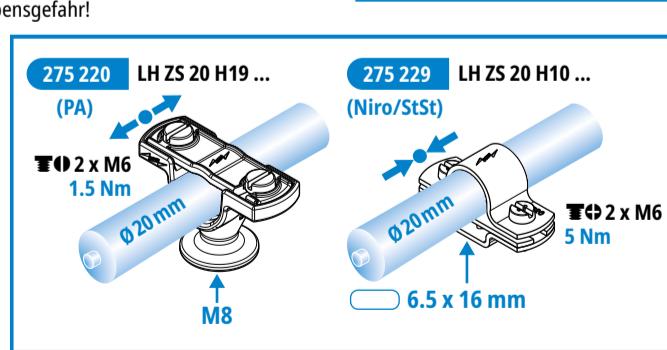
für Montage MIT Abstand zur Gebäudewand
